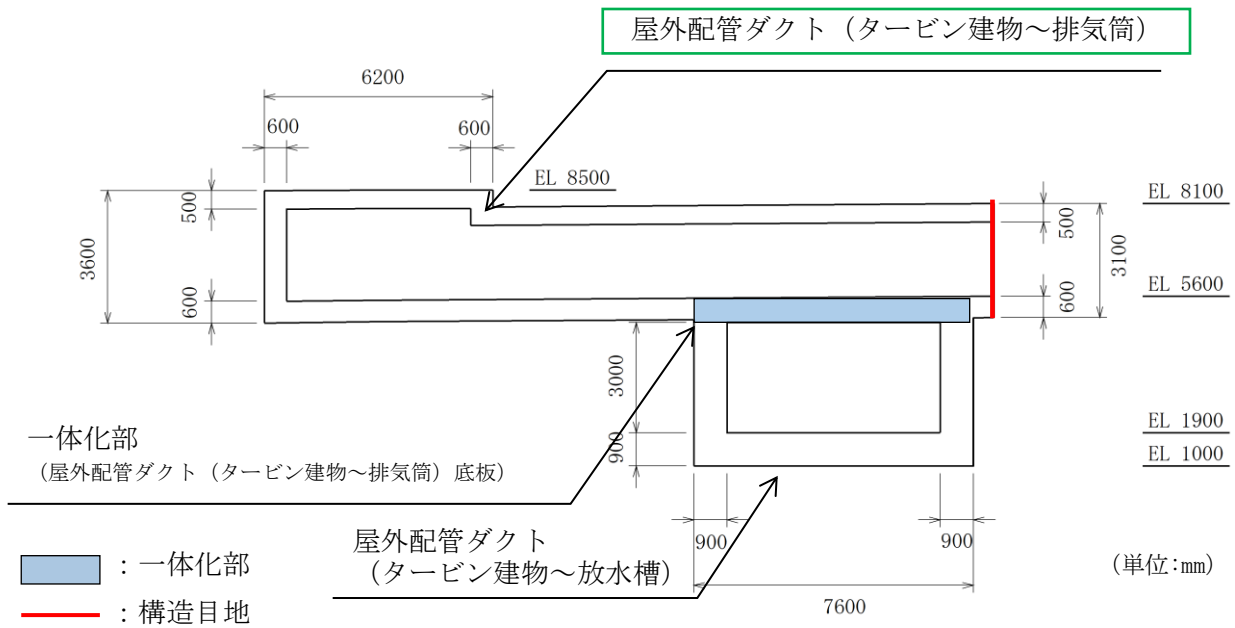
屋外配管ダクト (タービン建物～排気筒) 断面図 (C-C断面)
